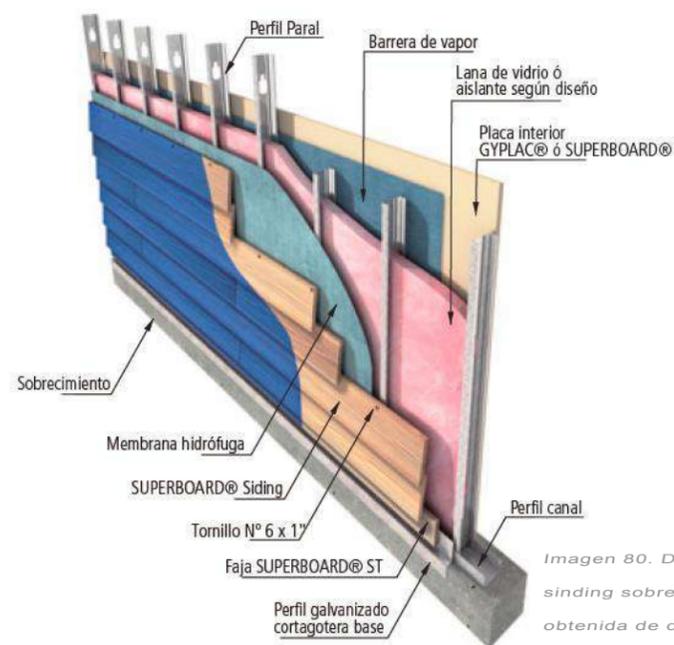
Detalle de constructivo siding sobre estructura metálica obtenida de del Manual Superboard Skirco pag. 38
